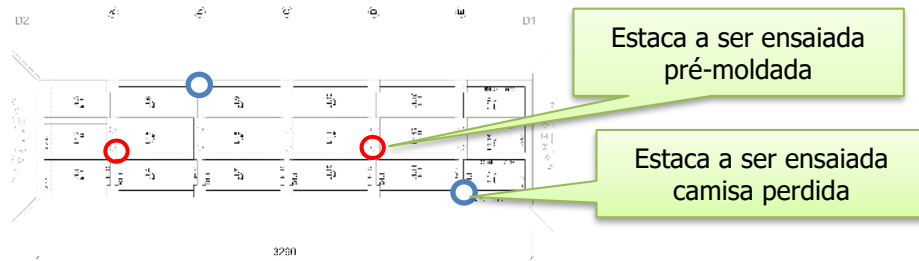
Estruturas dos trechos típicos (Estel Engenharia)
